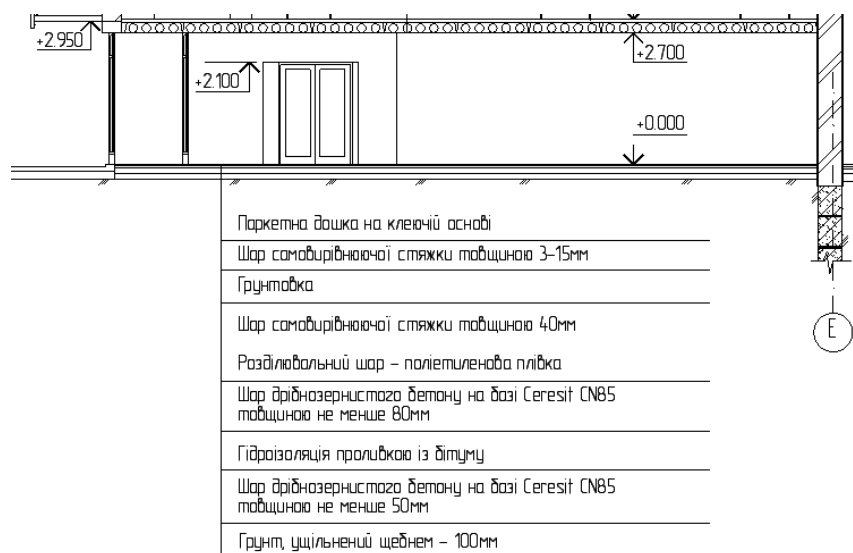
Конструкція підлоги у межах двоповерхової будівлі
